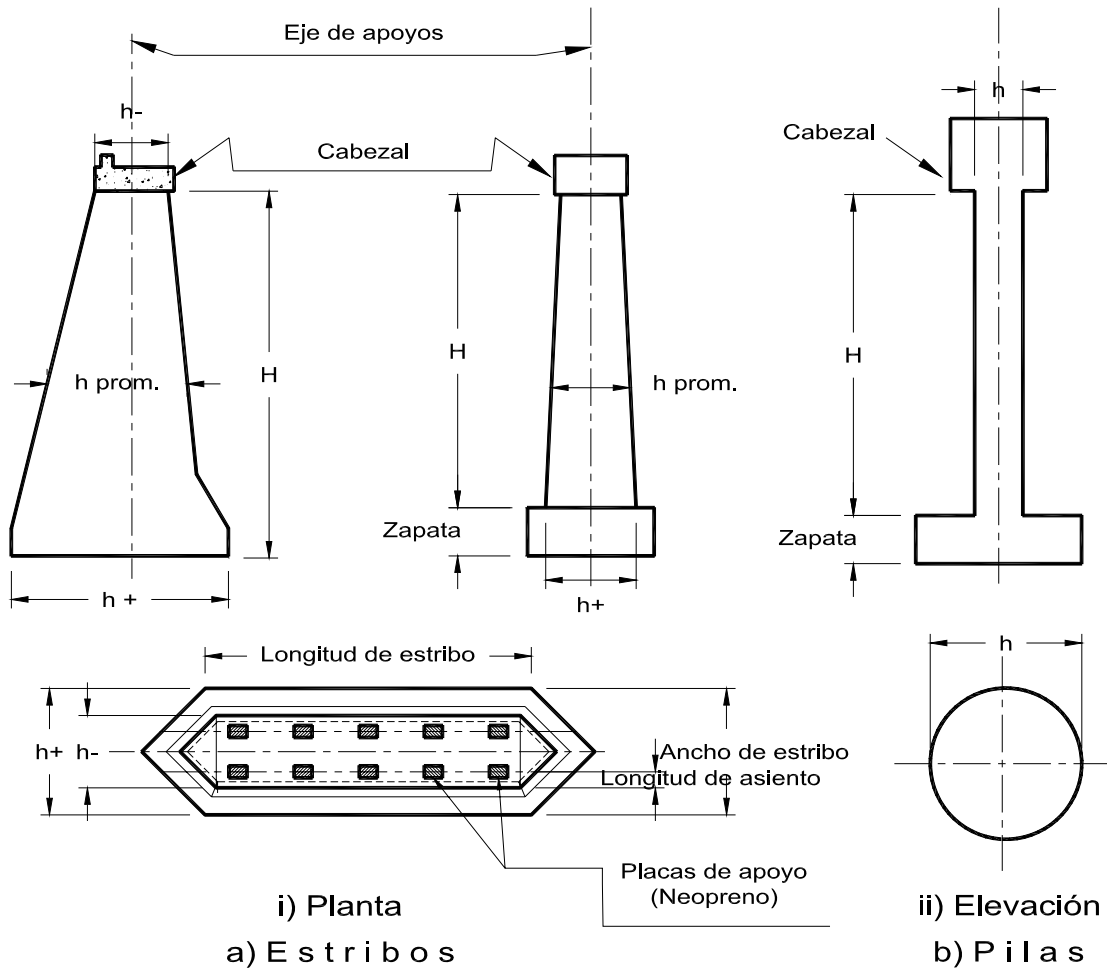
Croquis de apoyos extremos e intermedios (estribos y pilas)
